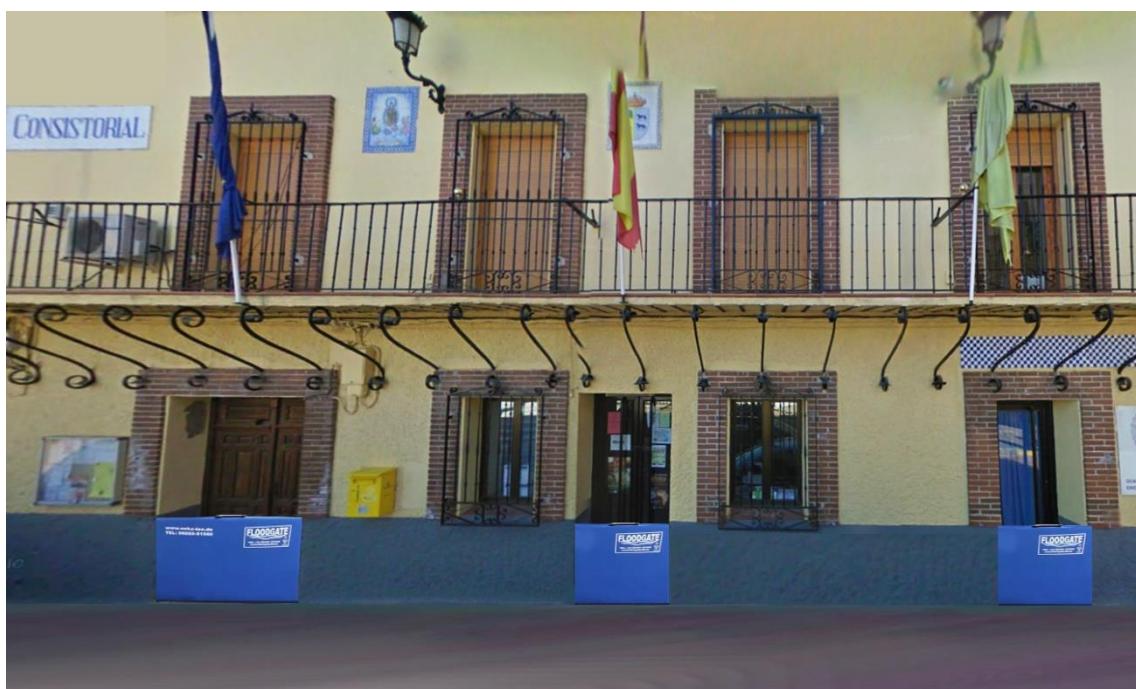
Ayuntamiento de Cebolla: propuesta de adaptación. Fachada a la Plaza del Ayuntamiento.
